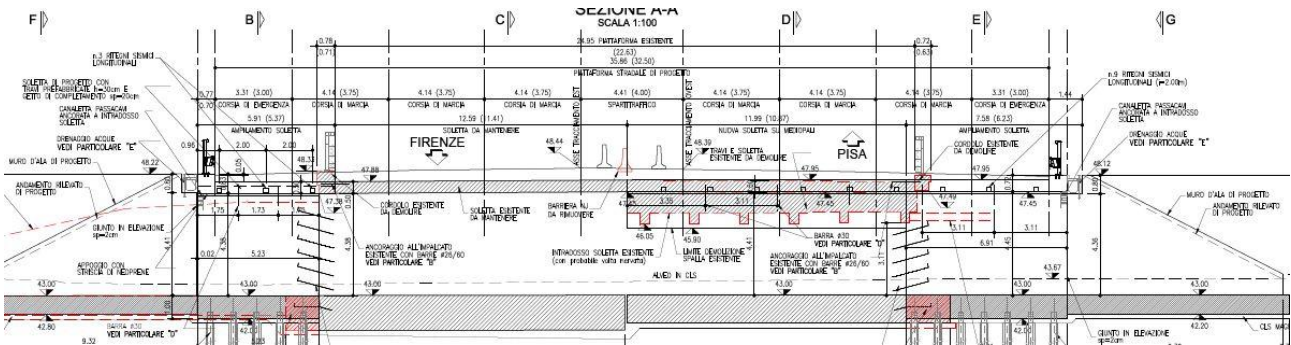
Sezioni tipo ampliamento.
